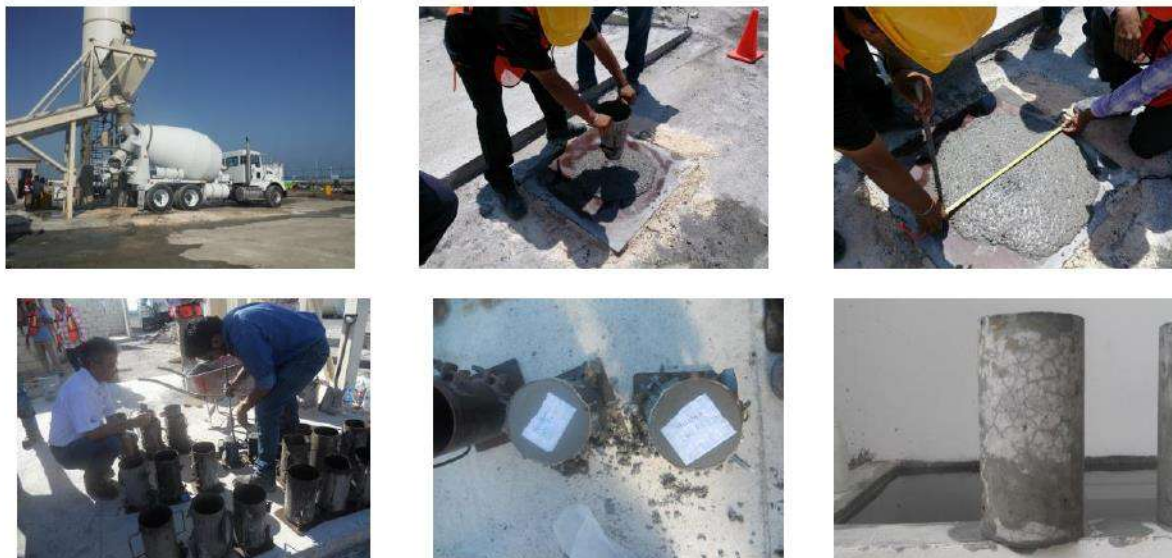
Procedimiento para el control de calidad del concreto auto consolidable de un puente construido sobre el mar: mezclado en planta junto a la obra; pruebas de extensibilidad del concreto fresco; fabricación de cilindros; cilindros de muestra fallidos (con grietas por contracción), por lo que la mezcla fue rechazada.
